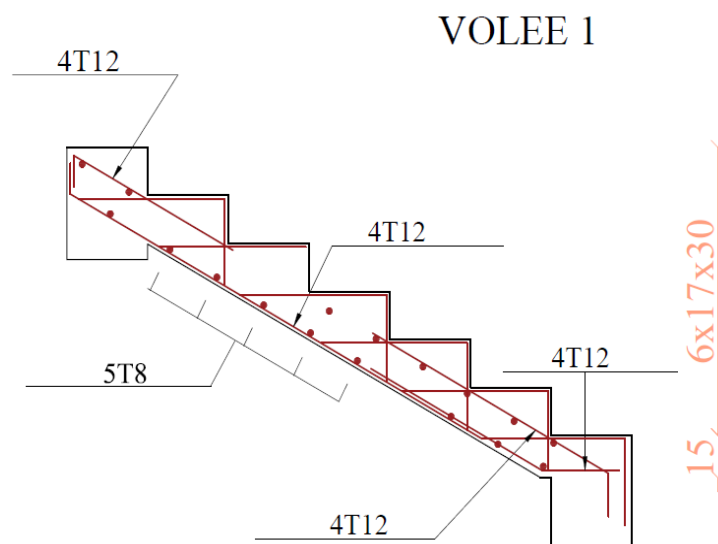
Schéma de ferrailage du 1^{ère} type d'escalier.
